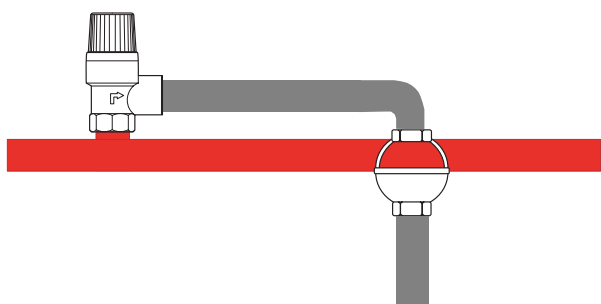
Installazione diretta dell' imbuto sulla tubazione di scarico
